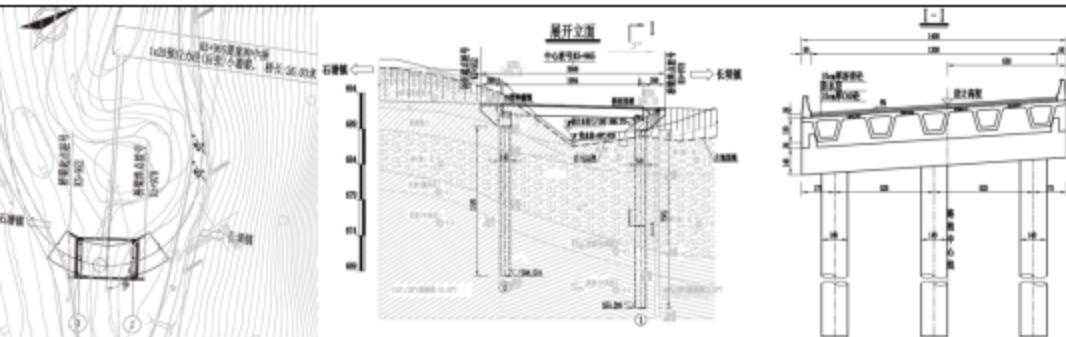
K5+965黄家沟中桥桥位、桥型平面布置图
